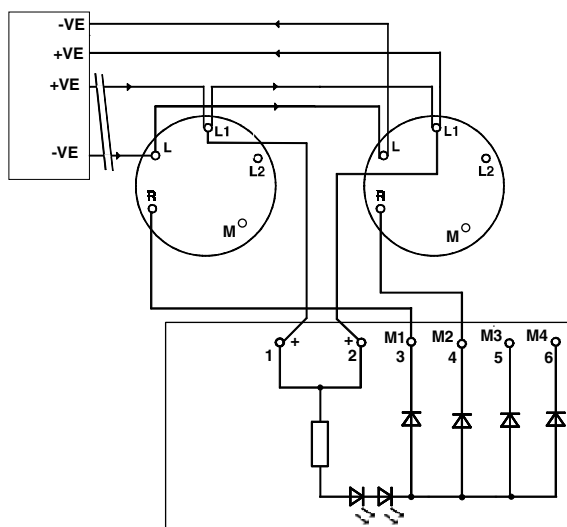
Cablaggio dell'indicatore LED remoto 801HL
